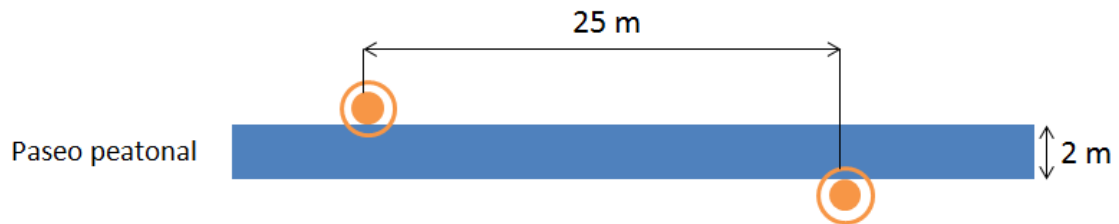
Calle de muestra tipo 2 iluminación exterior instalaciones existentes
